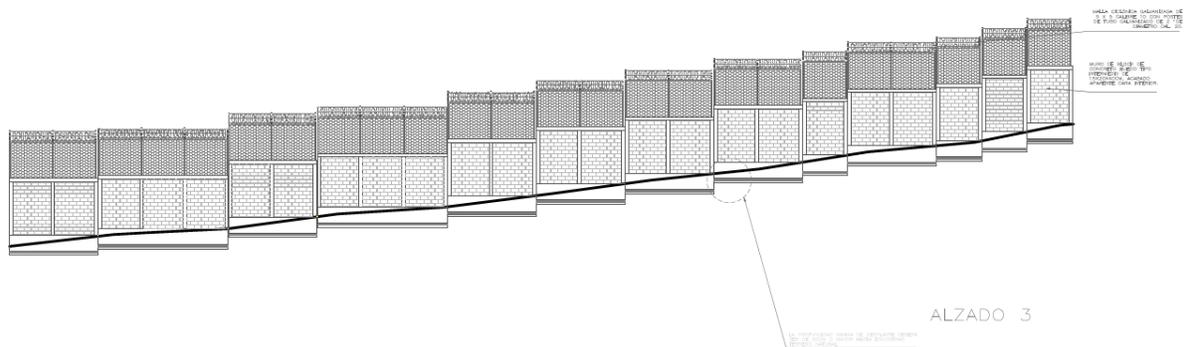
Alzado tramo 3 de barda perimetral proyectado.
